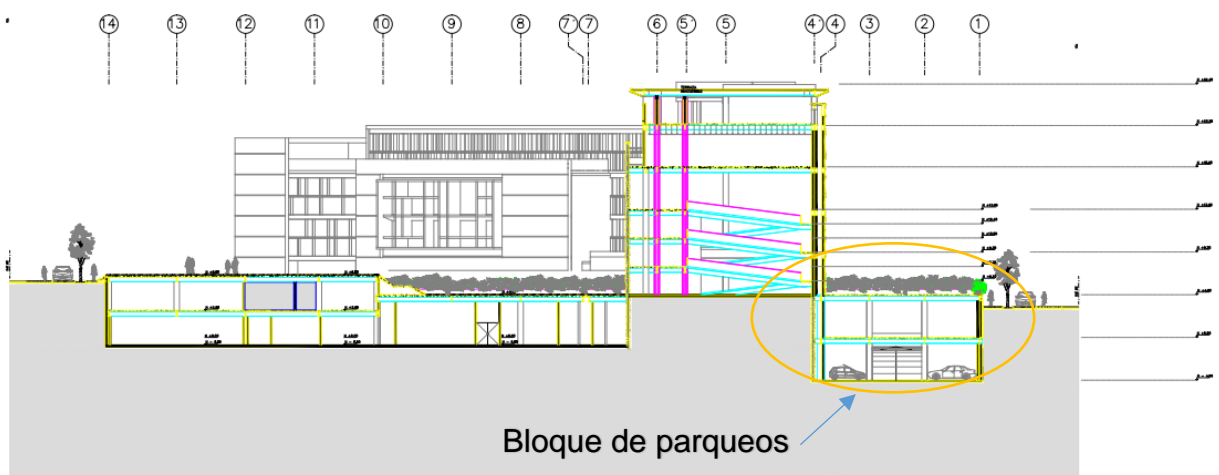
Corte Estructura Bloque de Parques Clúster de la Tierra. FUENTE: Planos Arquitectónicos Proyecto Yachay
